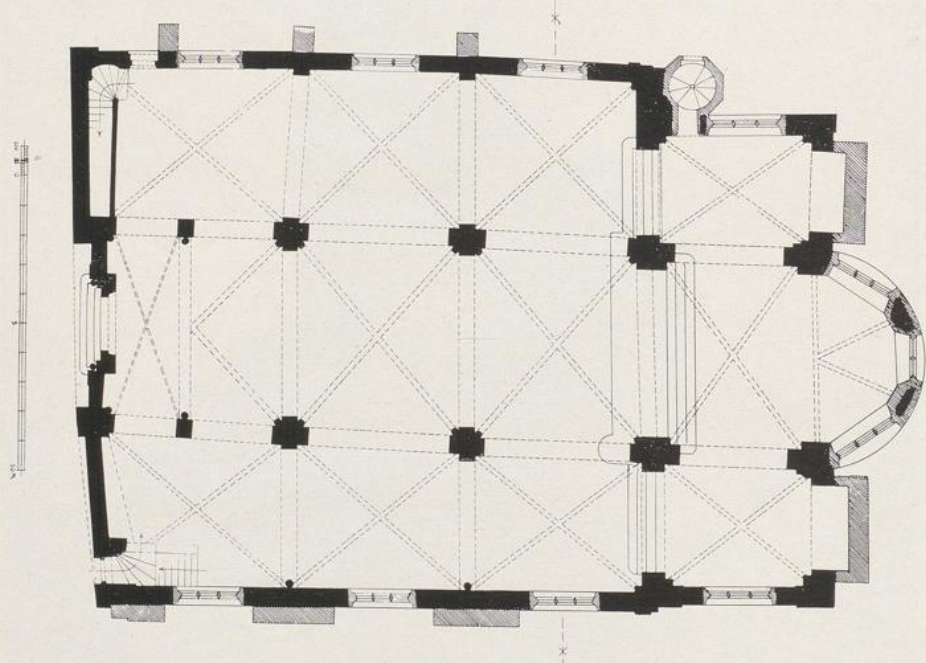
St.-Maria-Lyskirchen. Grundriss.
